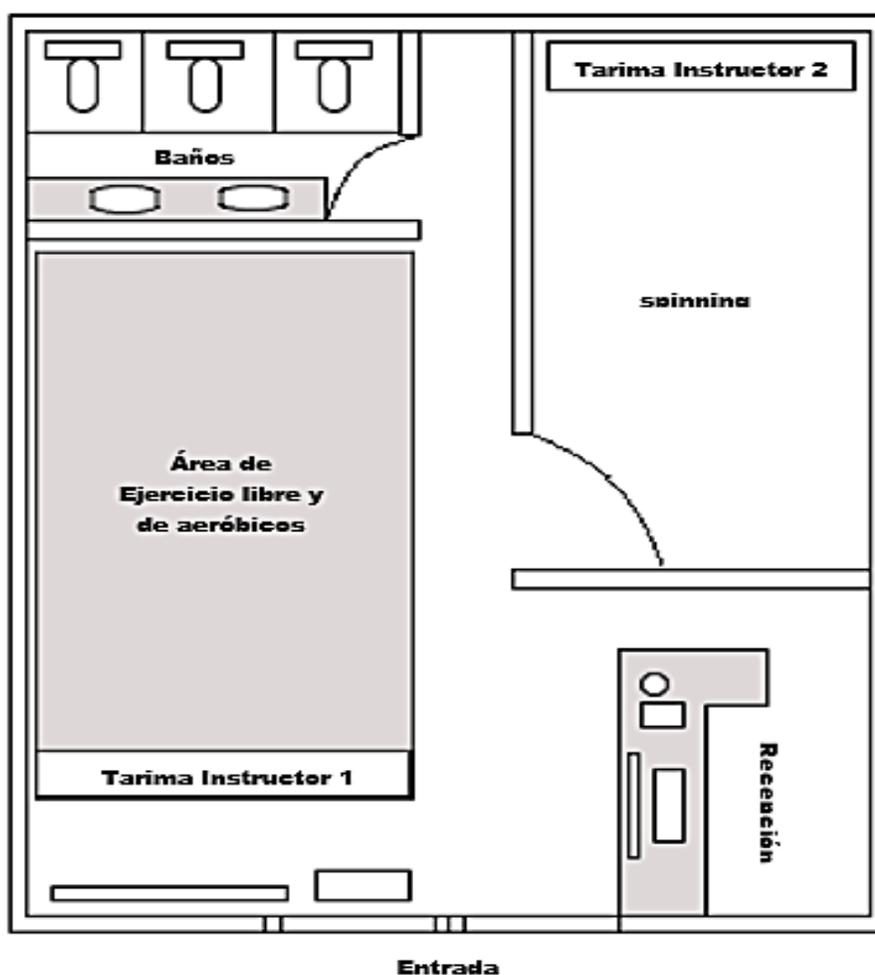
Distribución de planta. Fuente: Autores del proyecto.
